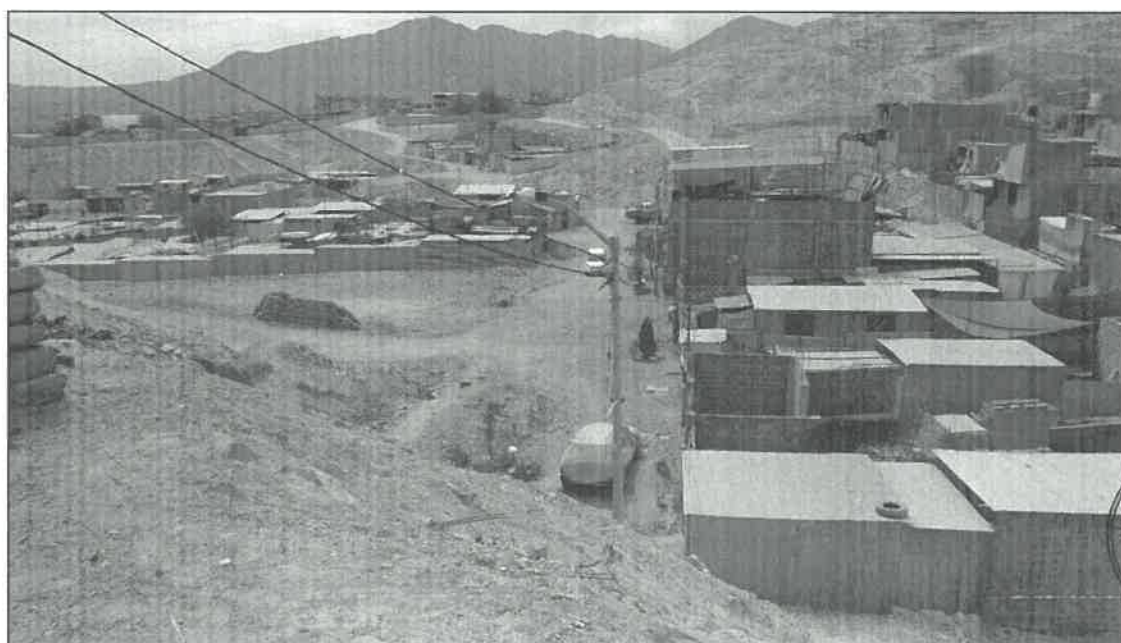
vista Calle 7 y Prolongación de Calle 7
